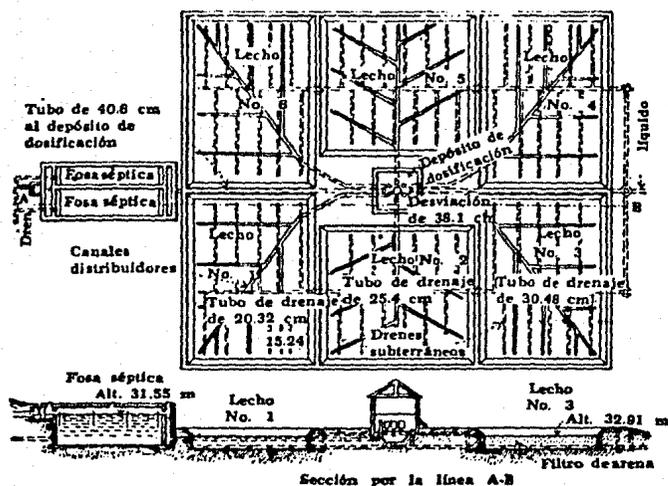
Planta y sección de un filtro intermitente de arena, que muestra la localización central de la caseta de control
